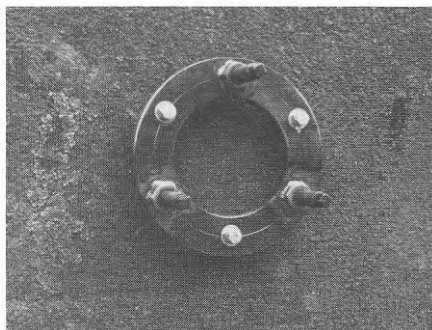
1 Stålring för fixering av utrustning för planborrning, kärnborrning, centreringsplatta och provdragning.
